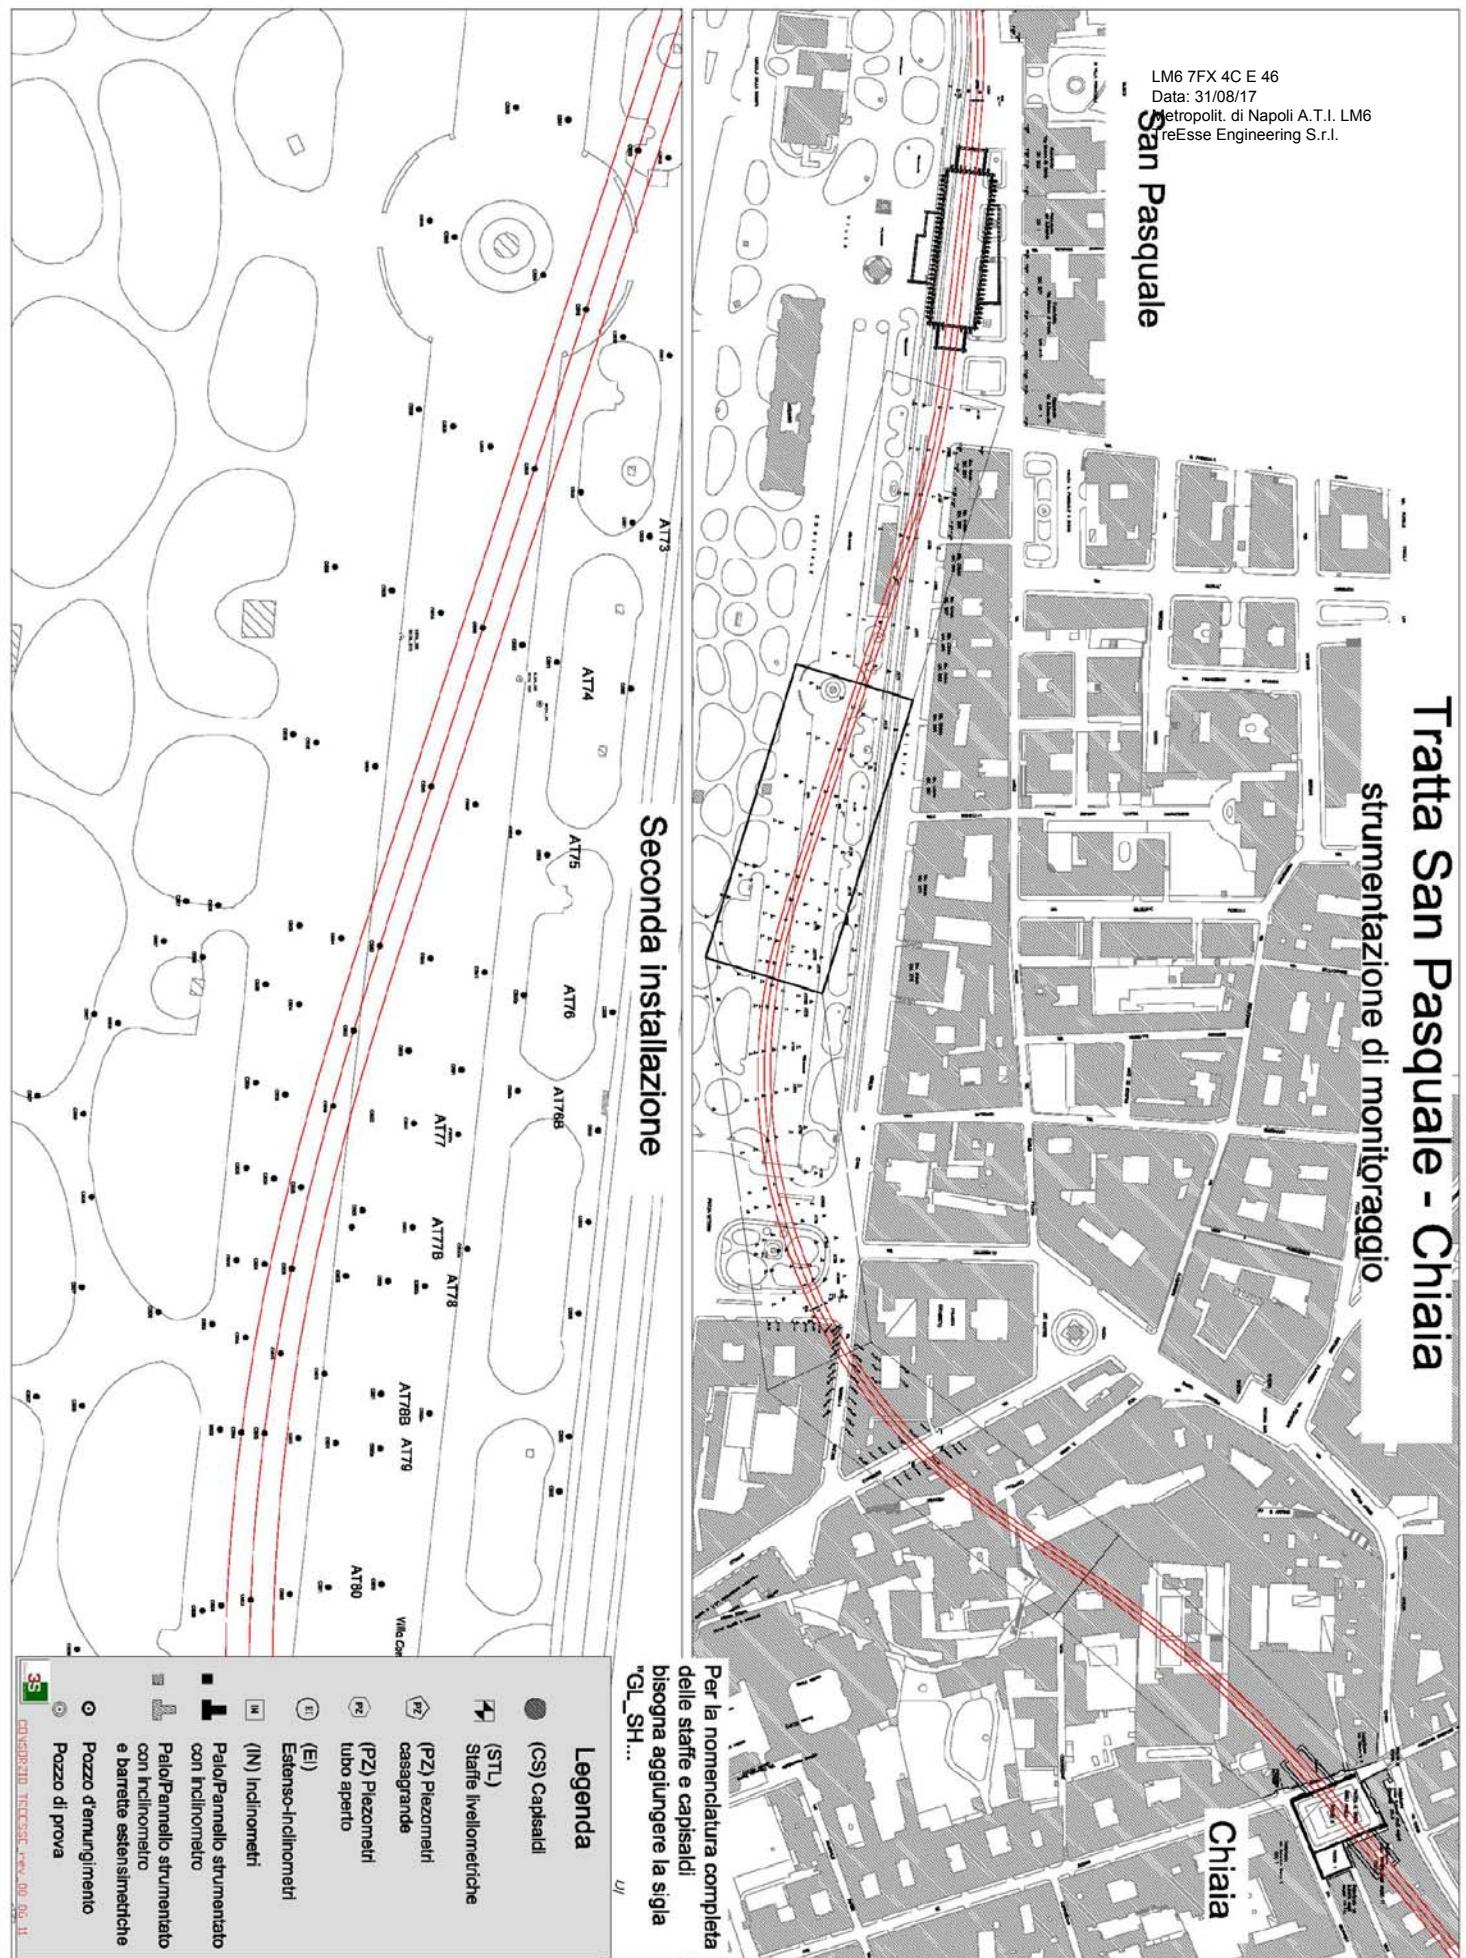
Planimetria tratta San Pasquale - Chiaia, raffigurante la disposizione della seconda installazione della strumentazione di monitoraggio.
